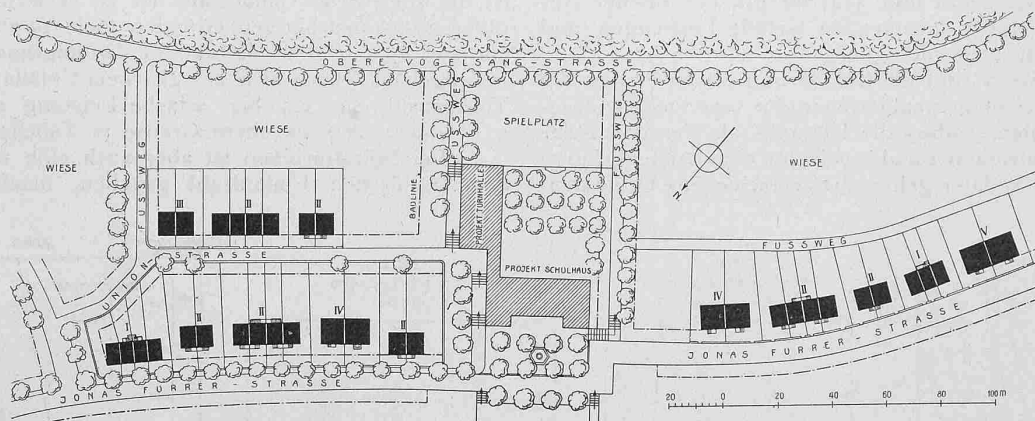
Eisenbahner-Kolonie im Vogelsang, Winterthur; erbaut durch Fritschi & Zangerl, Architekten. — Lageplan 1:2500.
